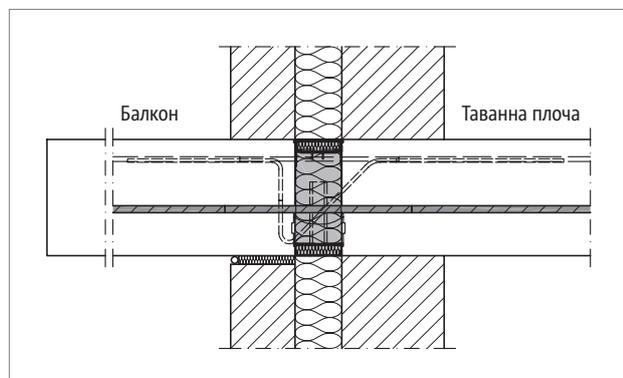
Schöck Isokorb® T mun HP: Конзолен балкон
